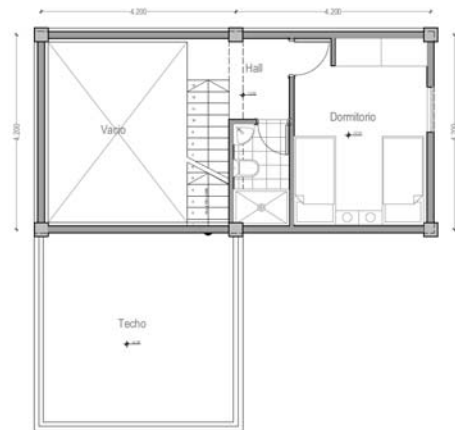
En el segundo piso, logra hacer entrar la escalera más un descanso sin tener un elemento estructural interrumpiendo. Elaboración propia.
